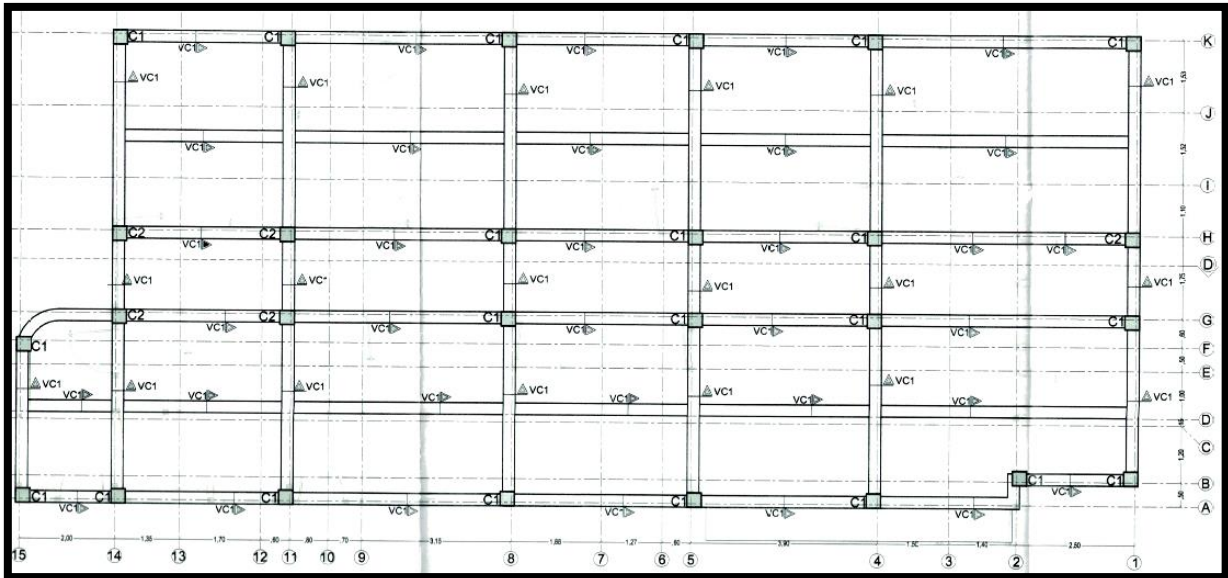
Planta de vigas de cimentación VC1 N-0.19m
